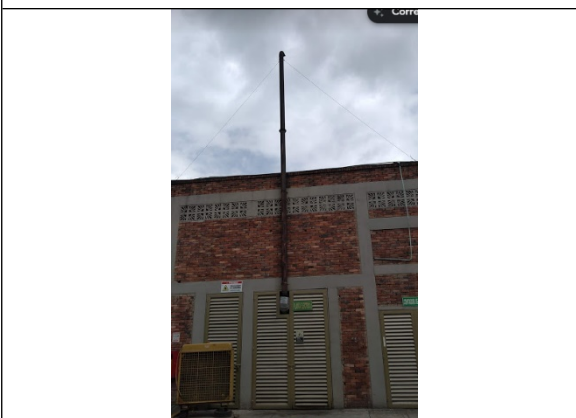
PLANTA ELECTRICA	FOTO No. 6 ENMASCARADOR DE OLORES
